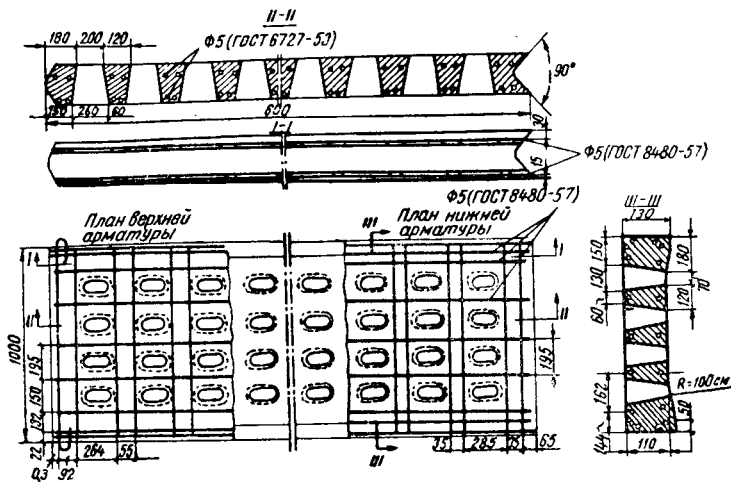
21. Плита с предварительно напряженной арматурой конструкции БТИ
